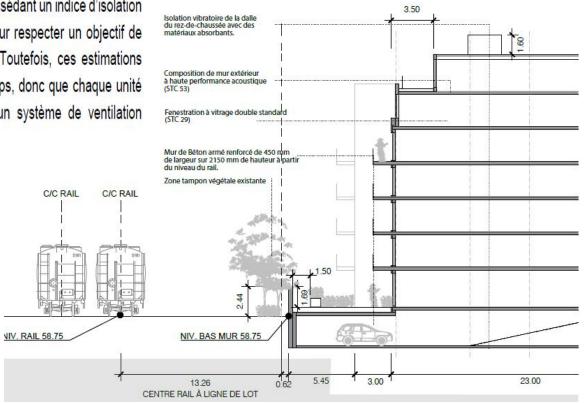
Mur structural de protection de 2,44 mètres (8'-0") minimum de hauteur en béton armé.
